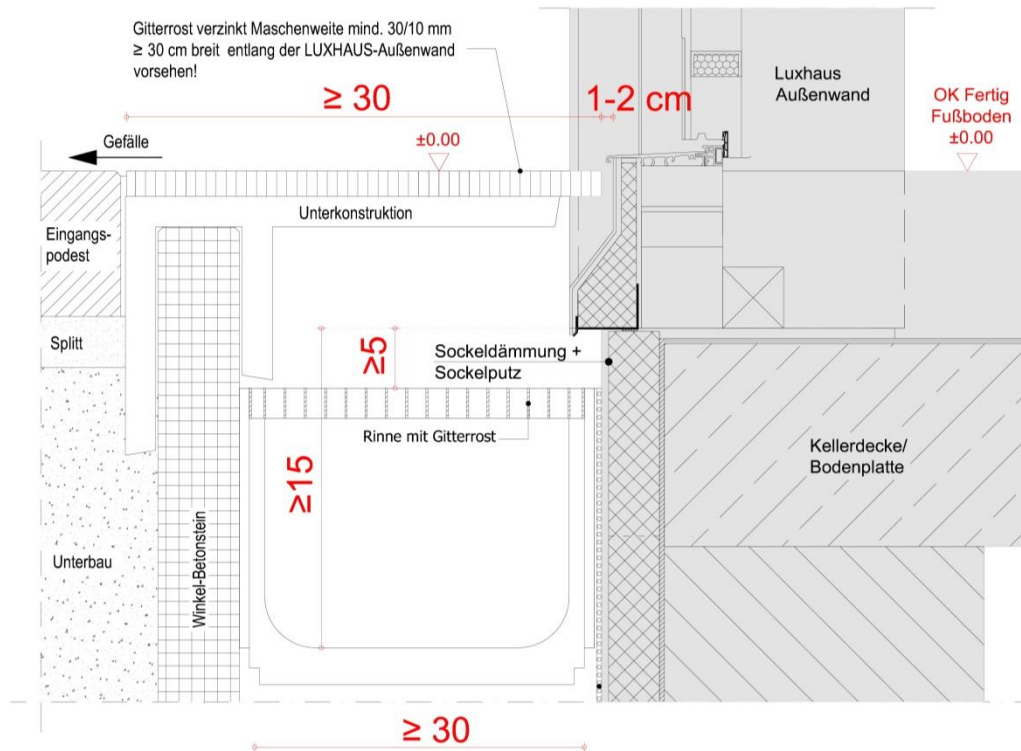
LUXHAUS Sockeldetail 8 - Hauseingang mit Rinne
